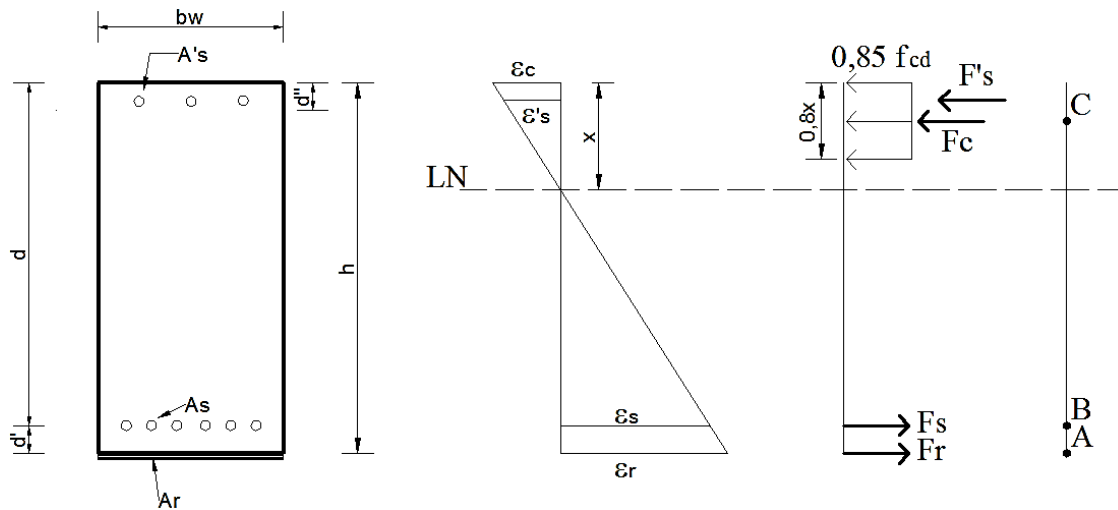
Equilíbrio de forças e deformações em uma viga de concreto armado
